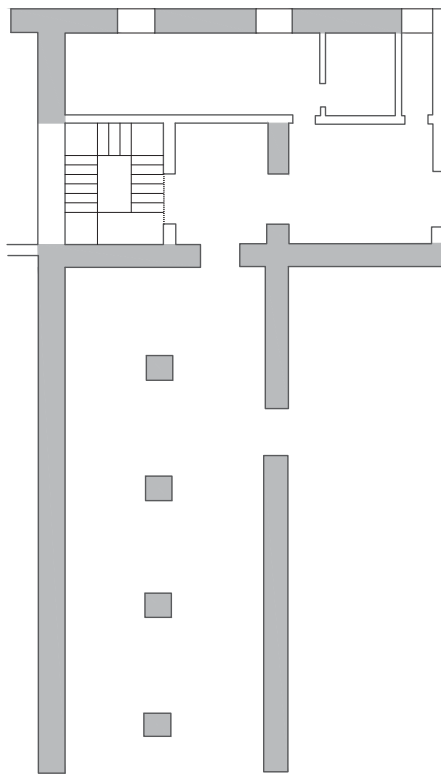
Plano de planta baja en 1805 con sombreado de elementos de 1727. (Fuente: elaboración propia a partir del plano de Josef Delgado)
